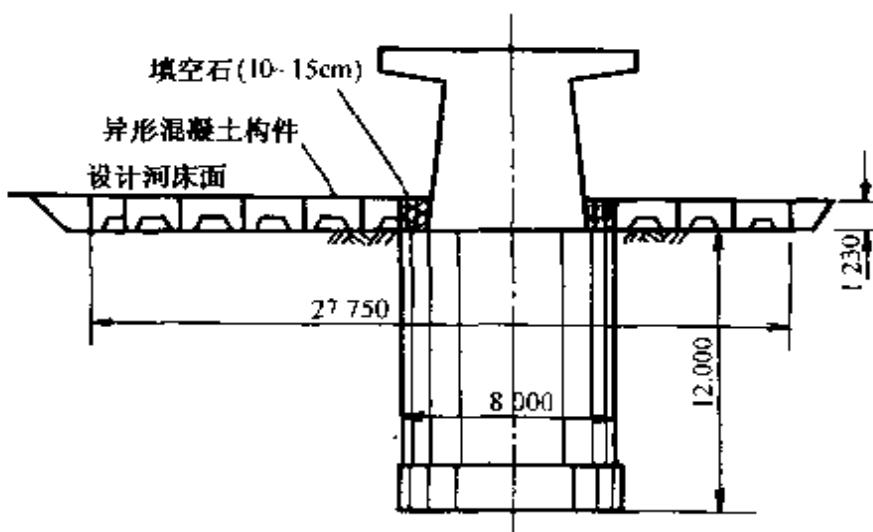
用护基工程加固基础的方法(尺寸单位:m)
